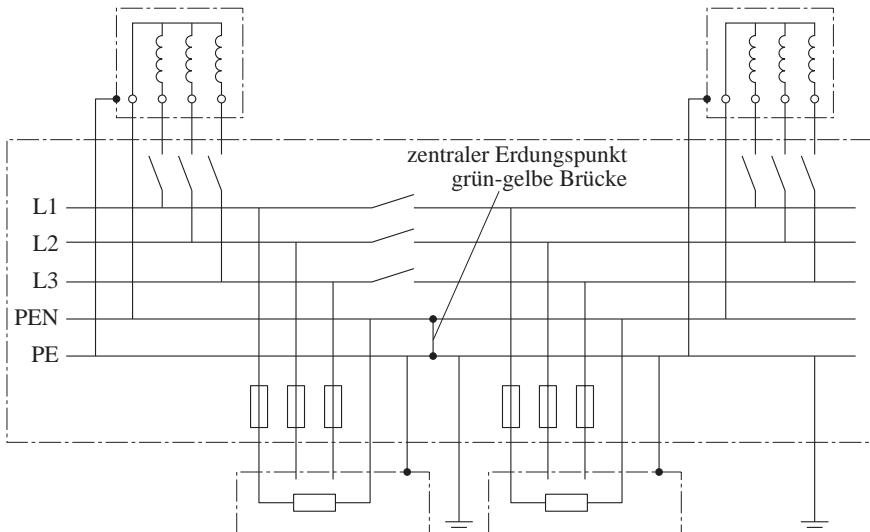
Mehrfacheinspeisung mit zentralem Erdungspunkt
